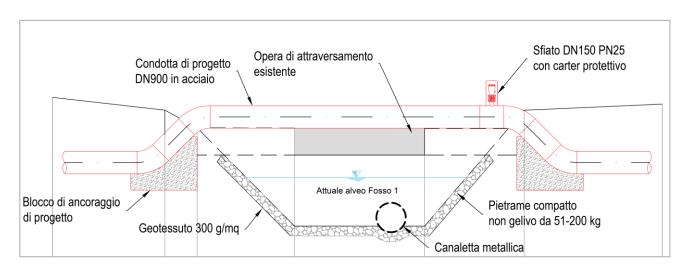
Sezione longitudinale attraversamento aereo autoportante di progetto sul Fosso 1.
